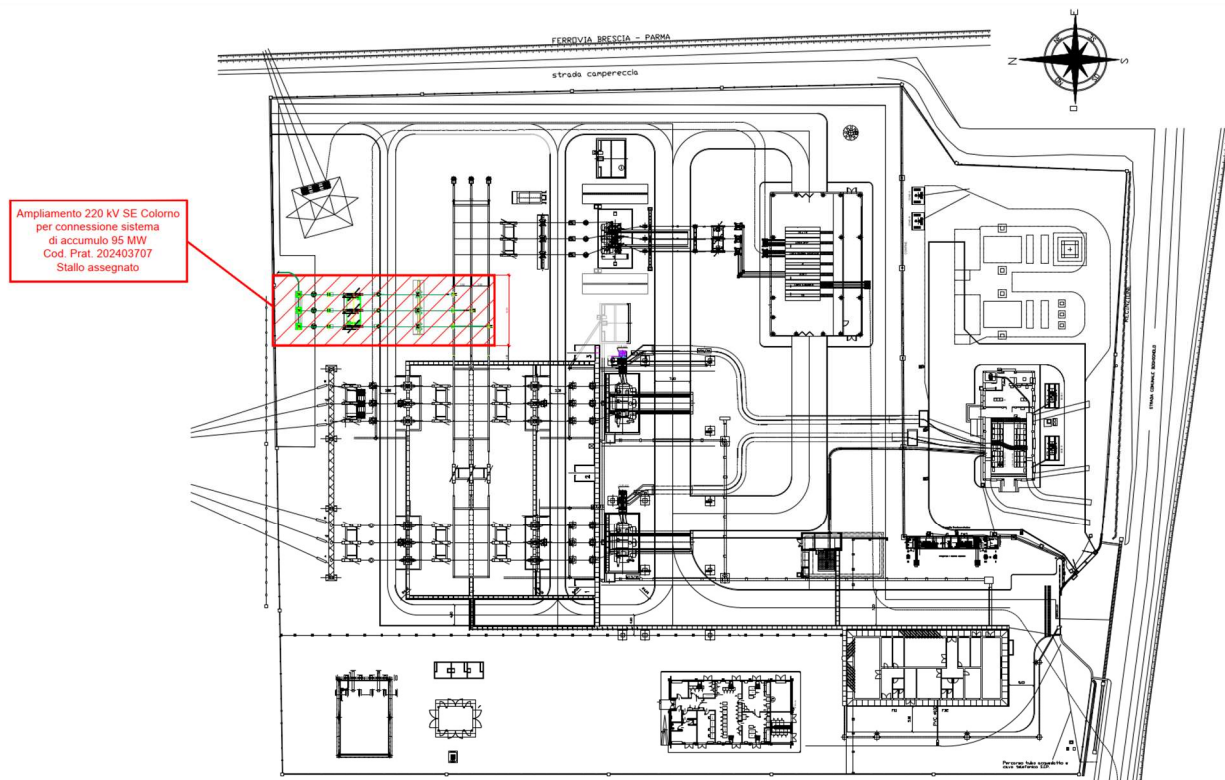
Planimetria elettromeccanica SE RTN "Colorno"
